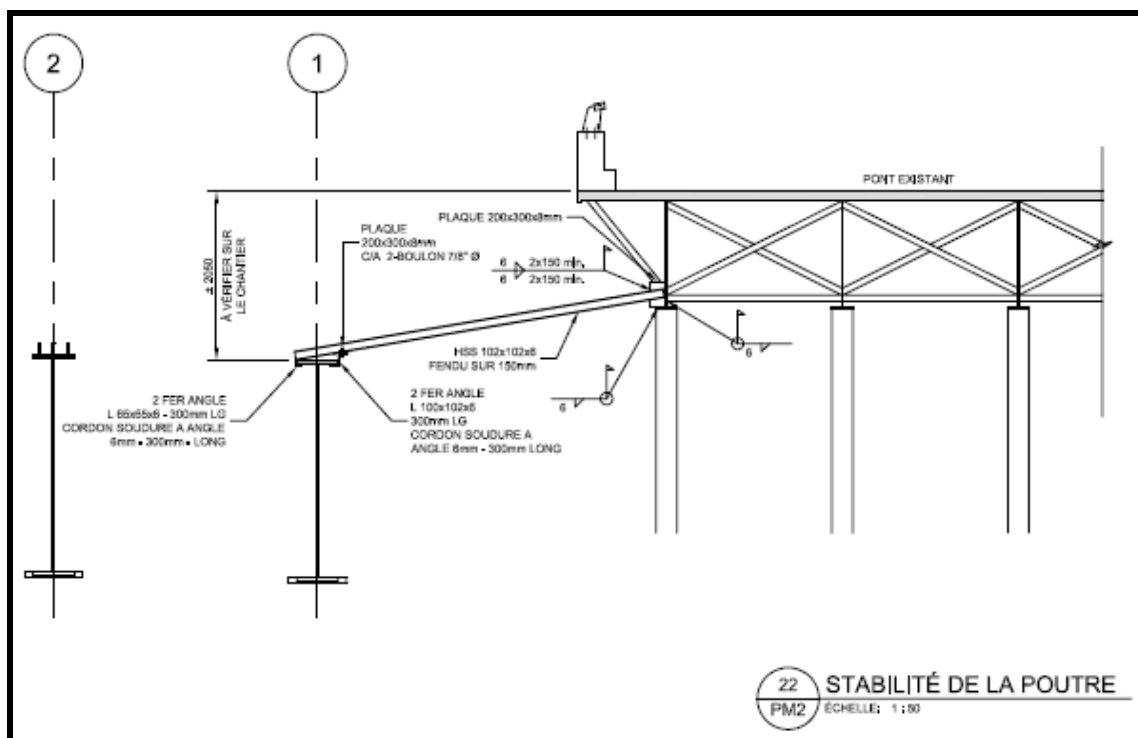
Installation des supports latéraux temporaires. Extrait du plan de montage PM4, réémis pour construction - 9 août 2015
